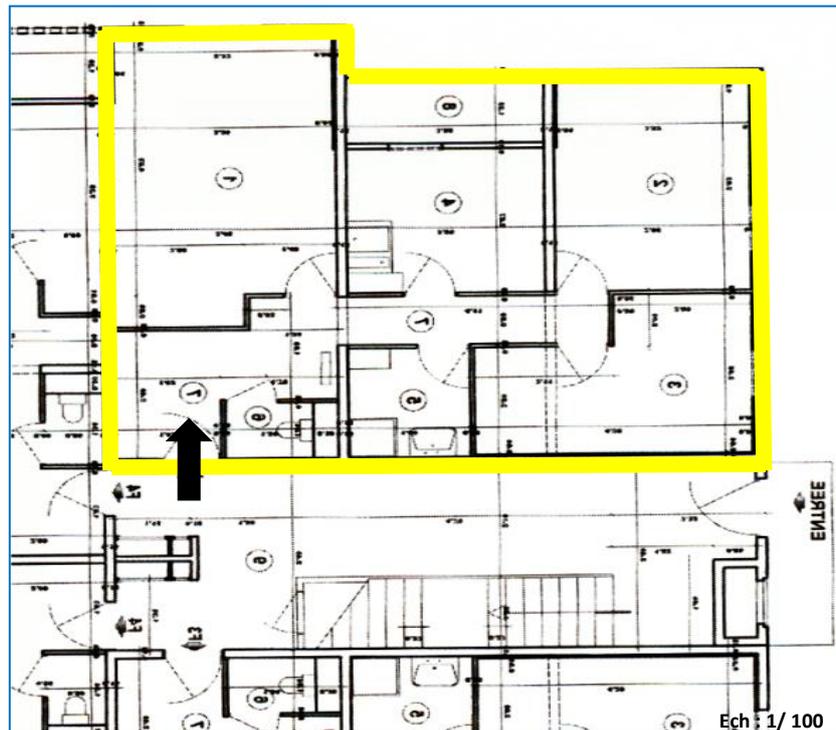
Disposition spatiale en plan du logement 01 en bloc 14. Source : Auteur, 2022
